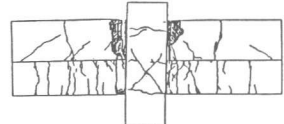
No.4(円形空洞目地) 最終ひび割れ状況
